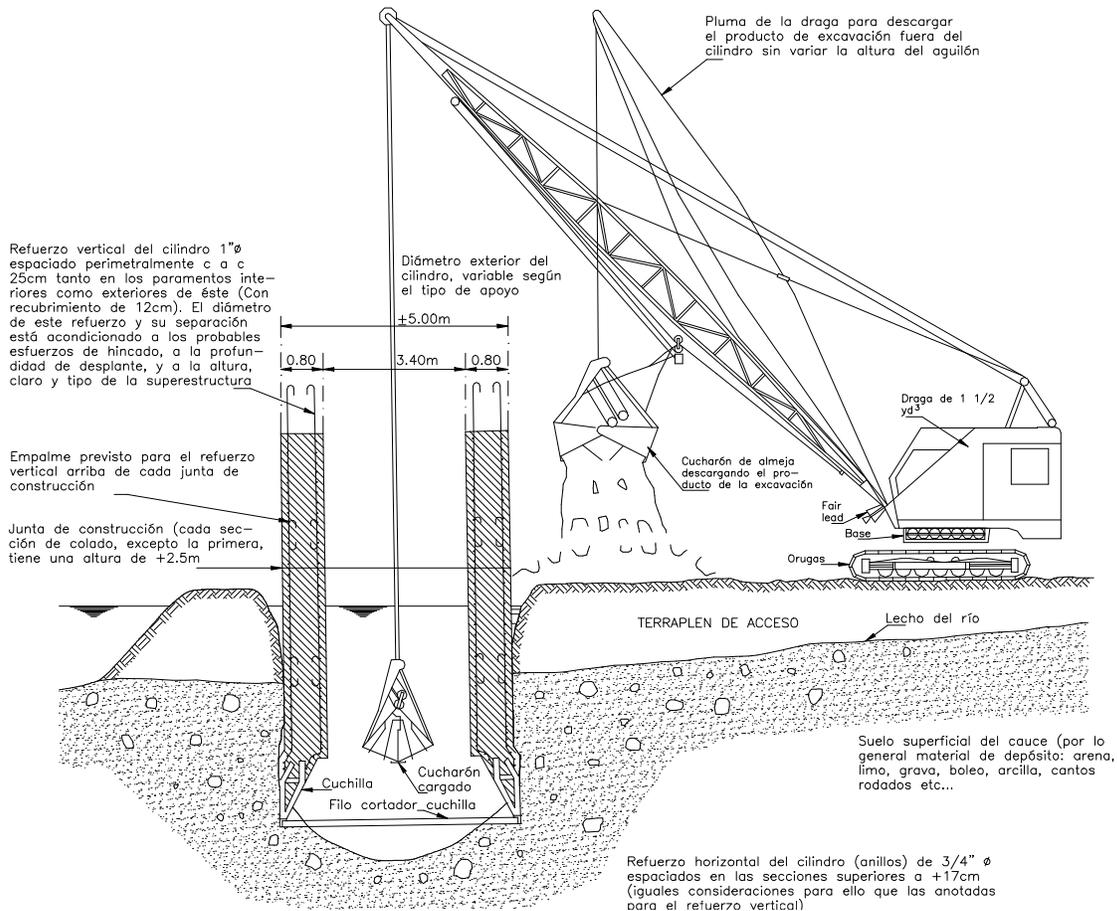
Hincado de un cilindro o cajón de cimentación.
